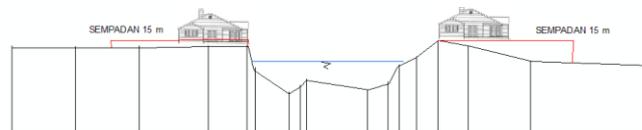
Tampilan Bentuk *Long Section* Sungai Gajah Wong
